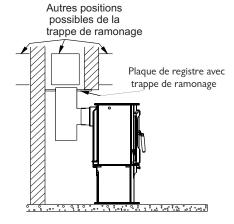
Plaque de registre horizontale avec branchement de conduit de fumée par le haut
